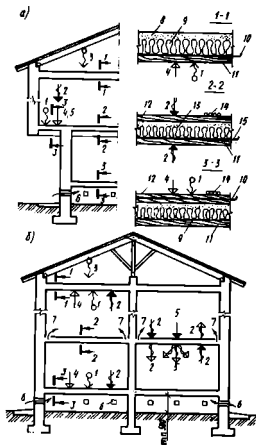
Перекрытия и основные воздействия на них (вертикальные нагрузки и горизонтальные силовые воздействия не показаны):
